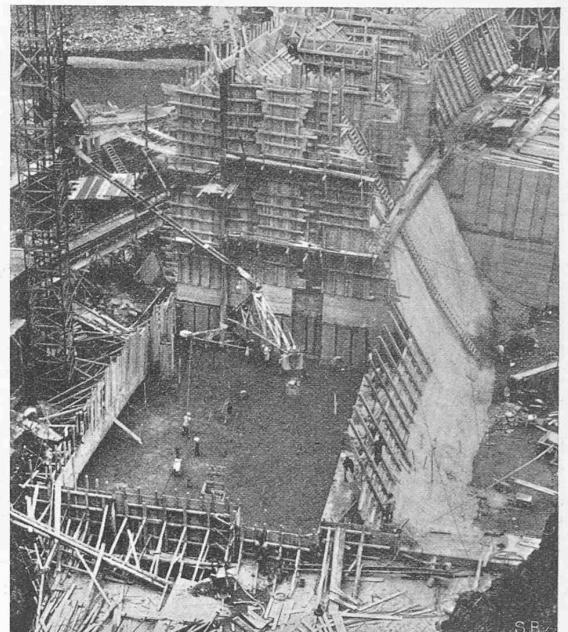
Betonieren des Ueberfalles der rechten Mauerhälfte, links der Giessturm 3b.
